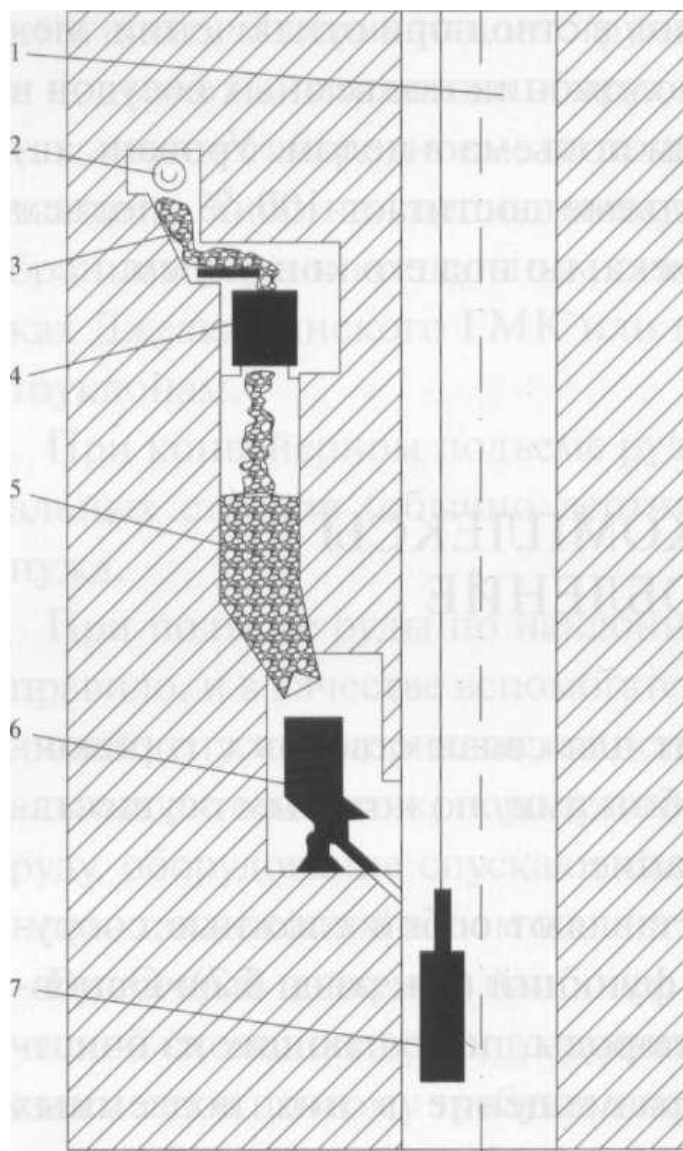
Схема подземного дробильно-перегрузочного узла при скиповом подъеме руды: 1 — скиповой ствол; 2 — круговой вагоно-опрокидыватель; 3 — приемный бункер подземной дробилки; 4 — подземная дробилка; 5 — бункер скипового подъема; 6 — дозирующее устройство; 7 — скип
